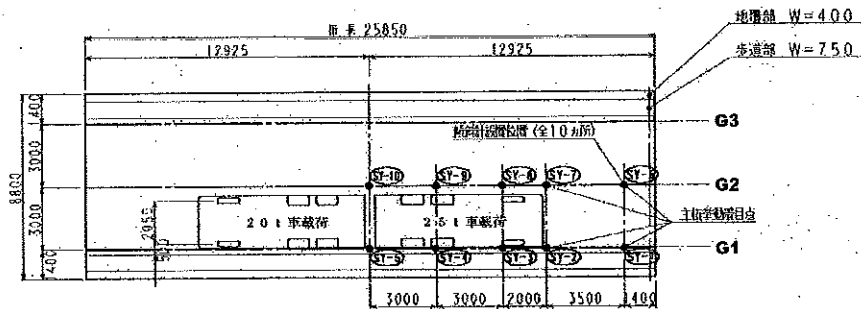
正徳橋の載荷車両配置及び傾斜計配置図
